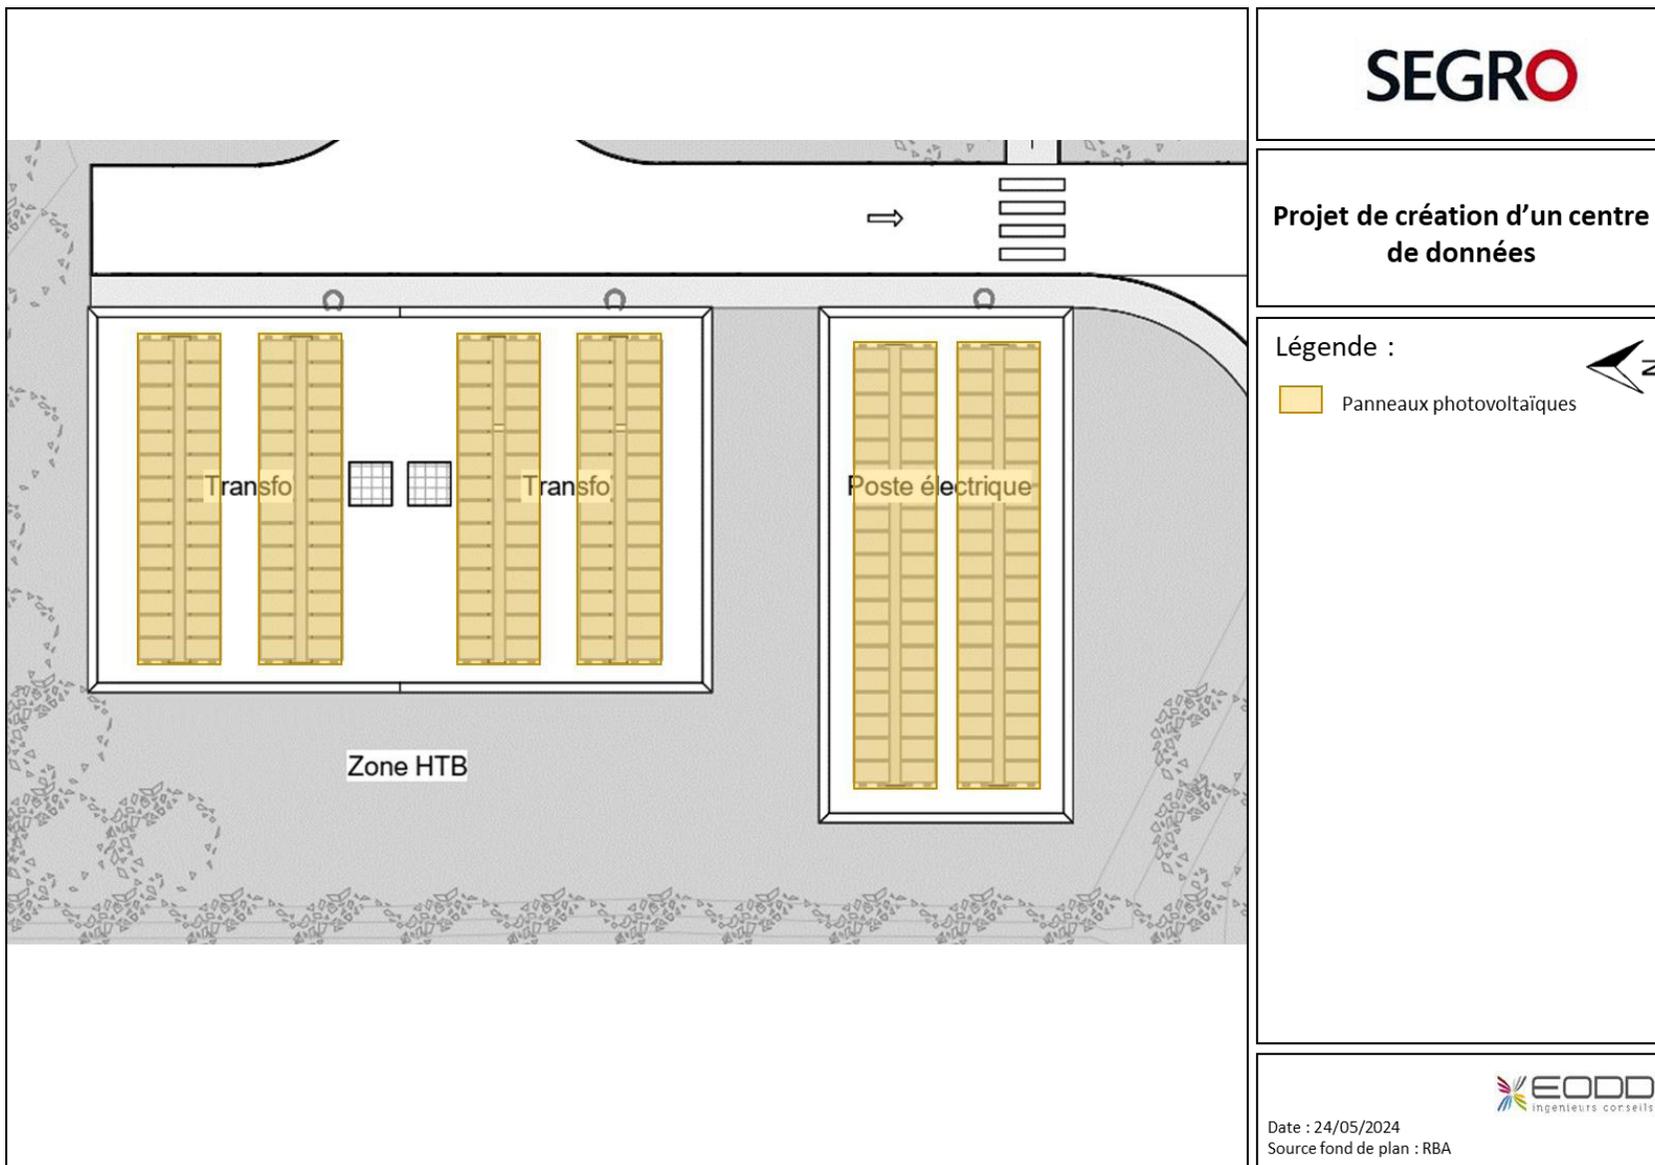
Localisation des panneaux solaires en toiture des locaux de la sous-station
